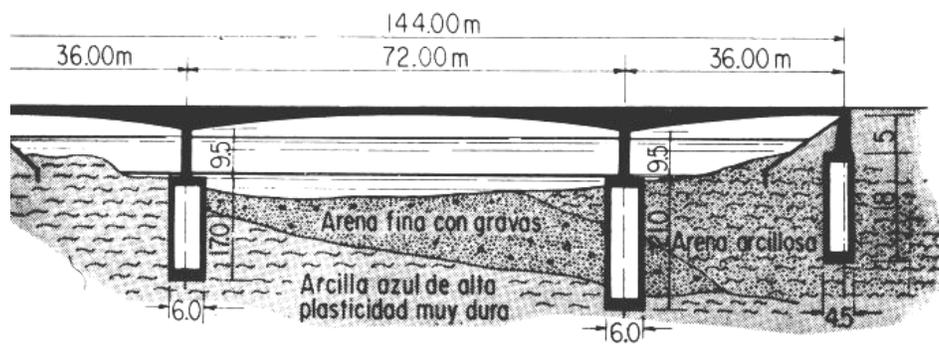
Plano esquemático del puente Bosques de las Lomas.
